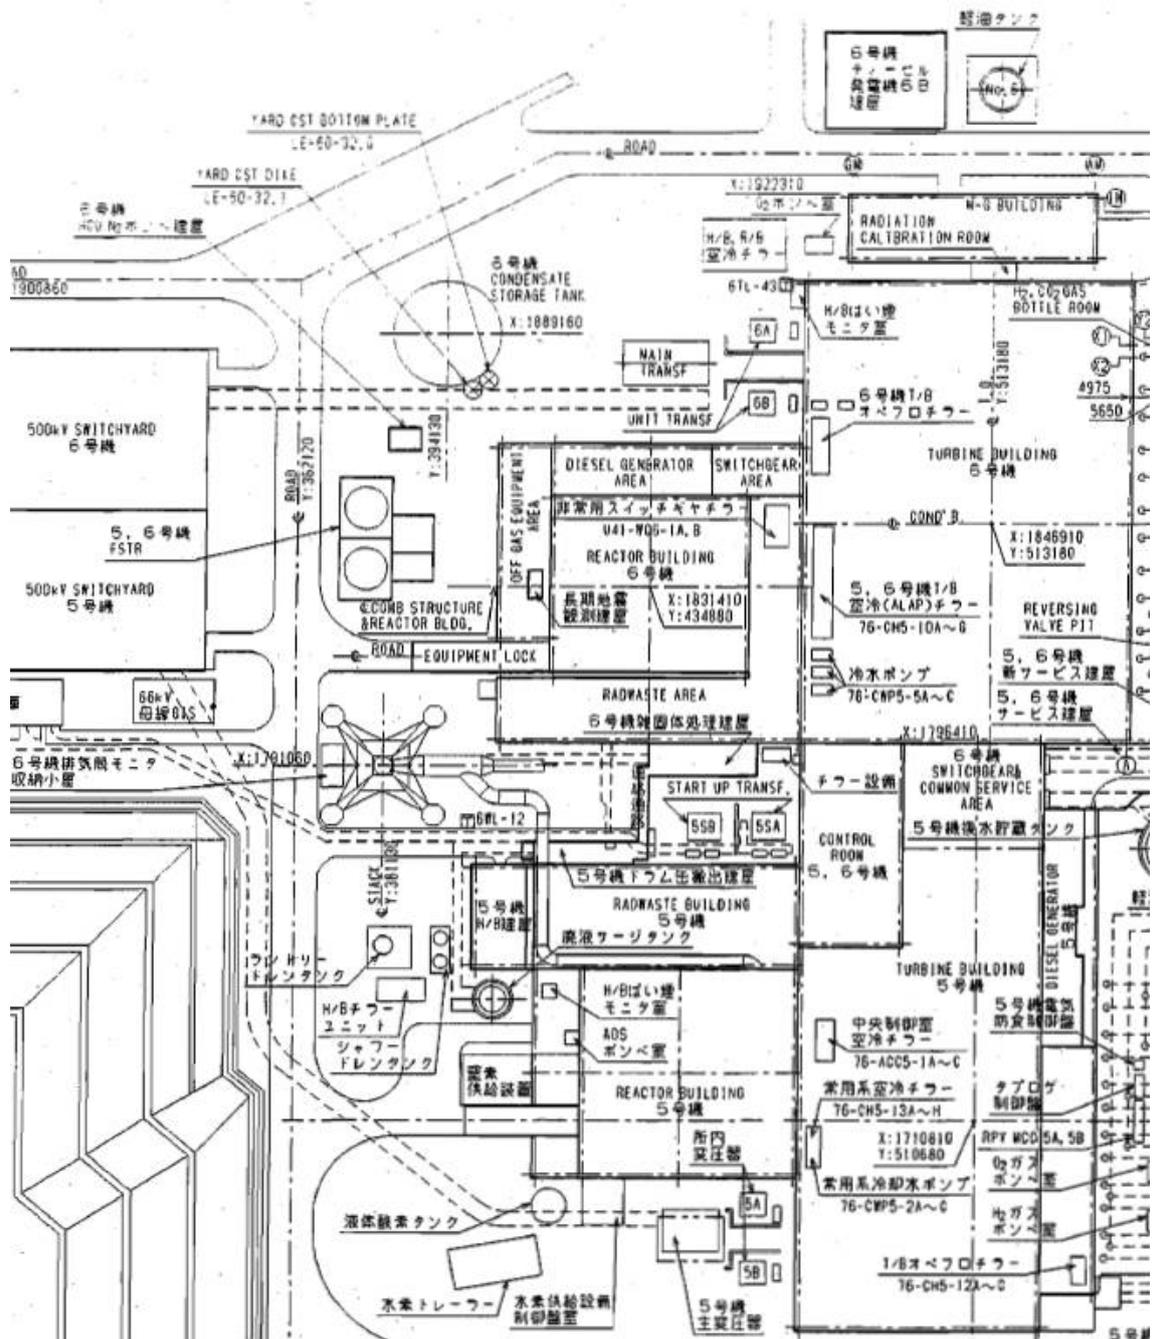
福島第一原子力発電所 5号機から 6号機 建屋平面図
